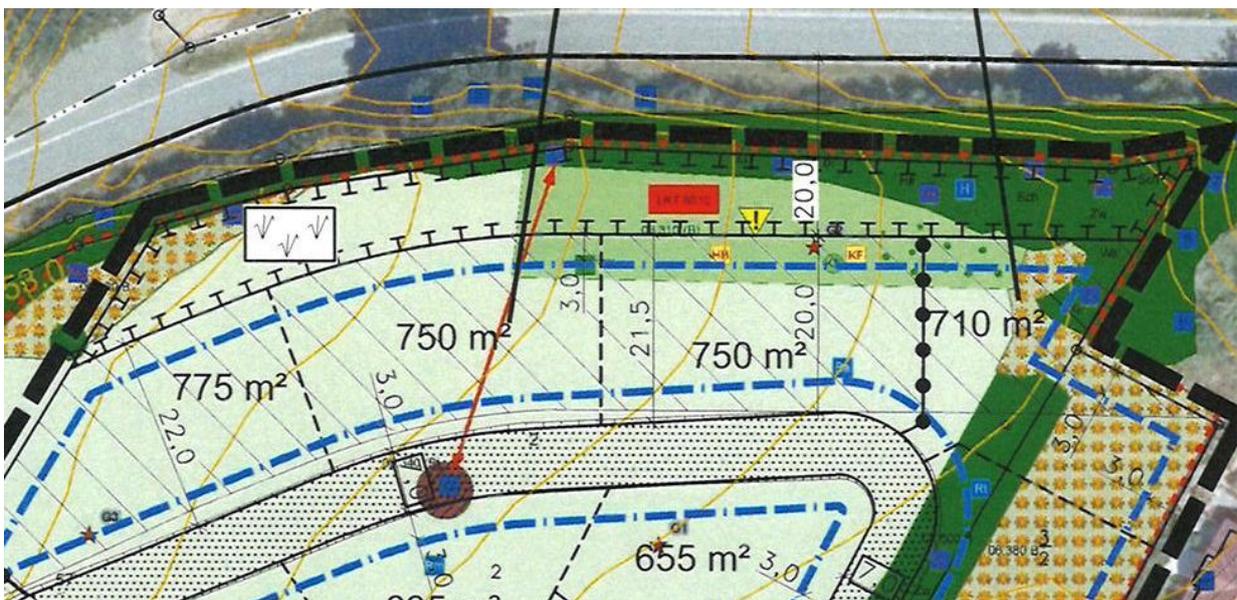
Überlagerung des Bestandsplanes mit der Planzeichnung des Baugebietes
